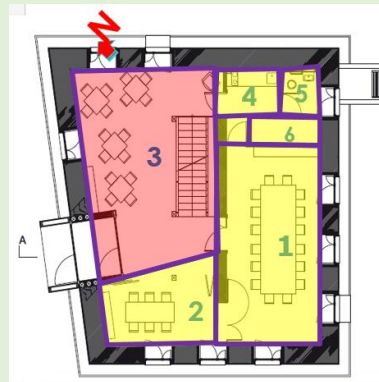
plan RDC de 2^{eme} exemple, MAGAZINE DE CHANTIER
